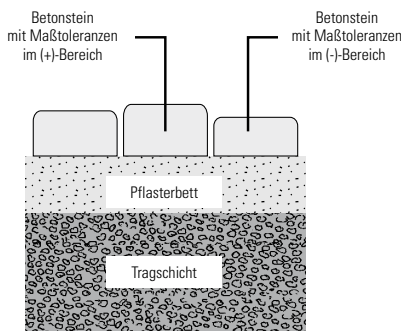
Verlegte Betonsteine auf abgezogenem Pflasterbett
